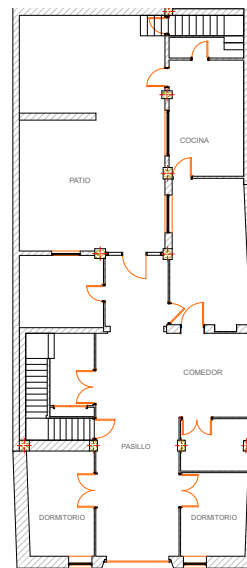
Vivienda objeto de estudio – Planta baja.2016.
